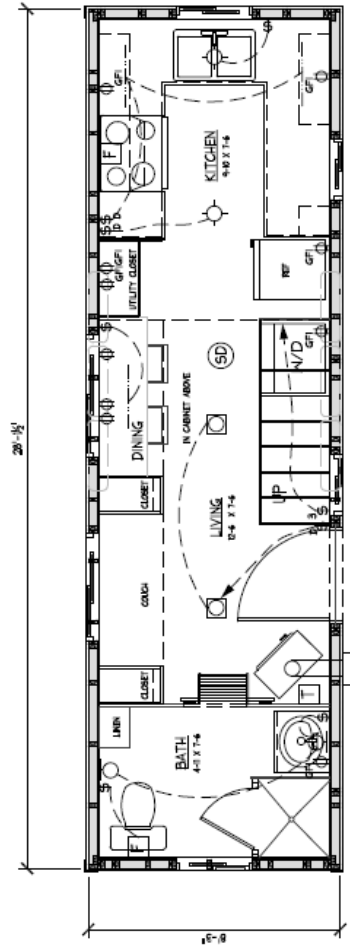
Planta arquitectónica de tiny house con estar, cocina y baño en planta baja 6.38 m² x 2.54 m². Fuente: Latiny, 2024
